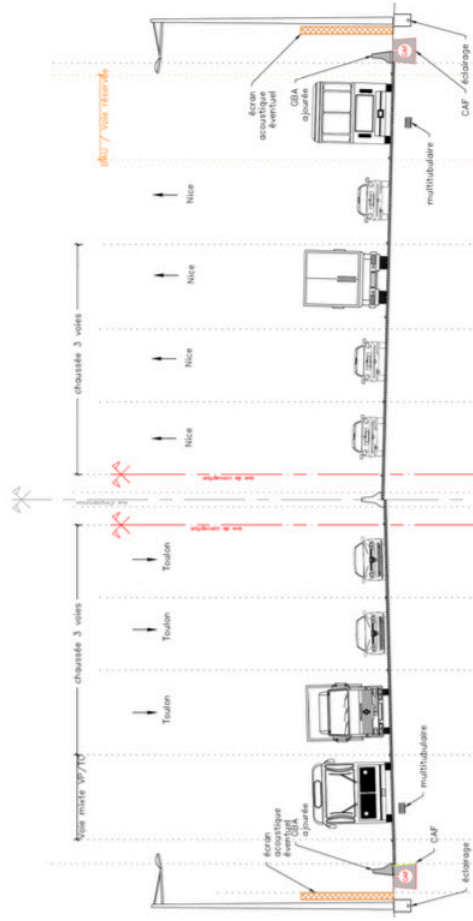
Profil en travers type – Section Tombadou vers les Fourches, en amont des Fourches
